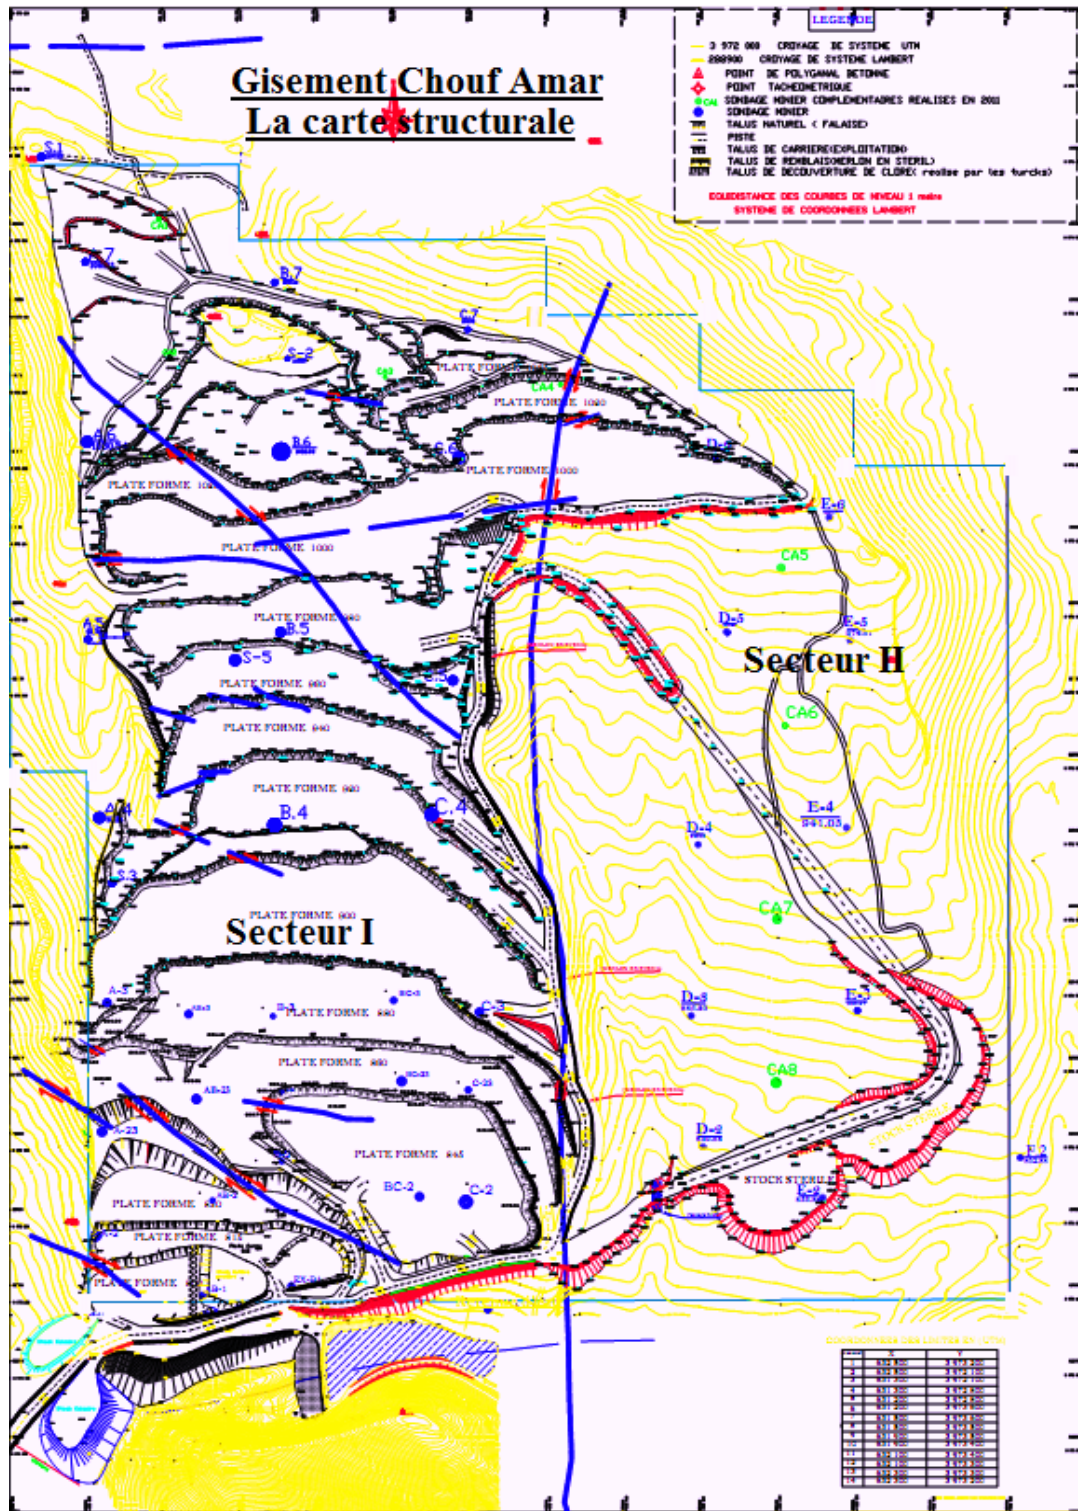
Plan de situation des ouvrages et des coupes longitudinales et transversales montrant la structure. (ADJOU Mokhtar/ CETIM 2014)
